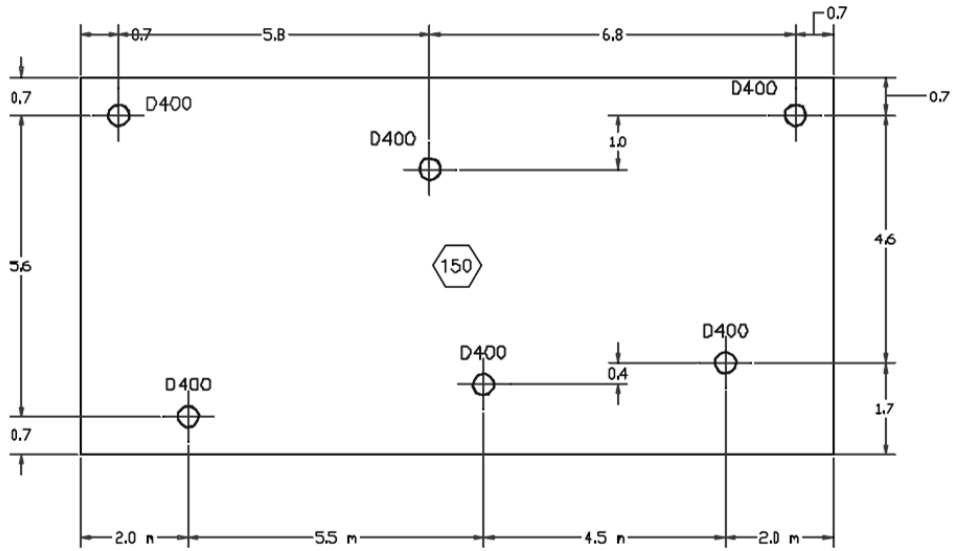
Planta do pavimento, medidas em metro (FARIA, 2004).
